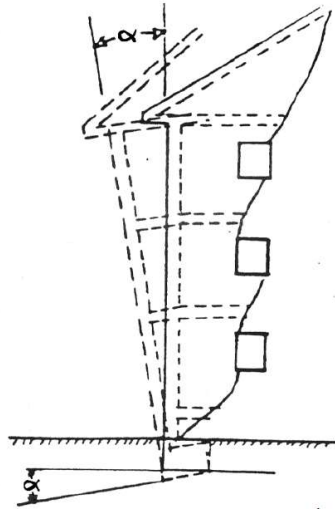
Inclinación de fachada debida a giro de zapata (López, Rodríguez, Santa Cruz, et al, 2004).
